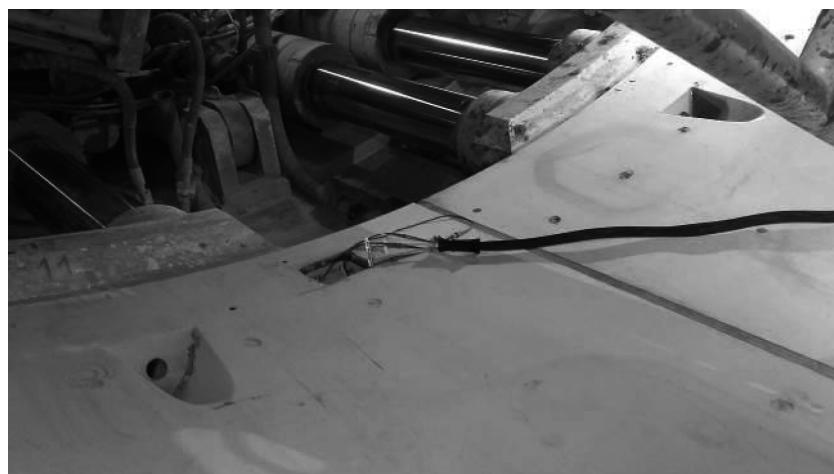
Extrémité d’un voussoir installé dans le tunnelier : connexion du boîtier aux câbles multifibres.
